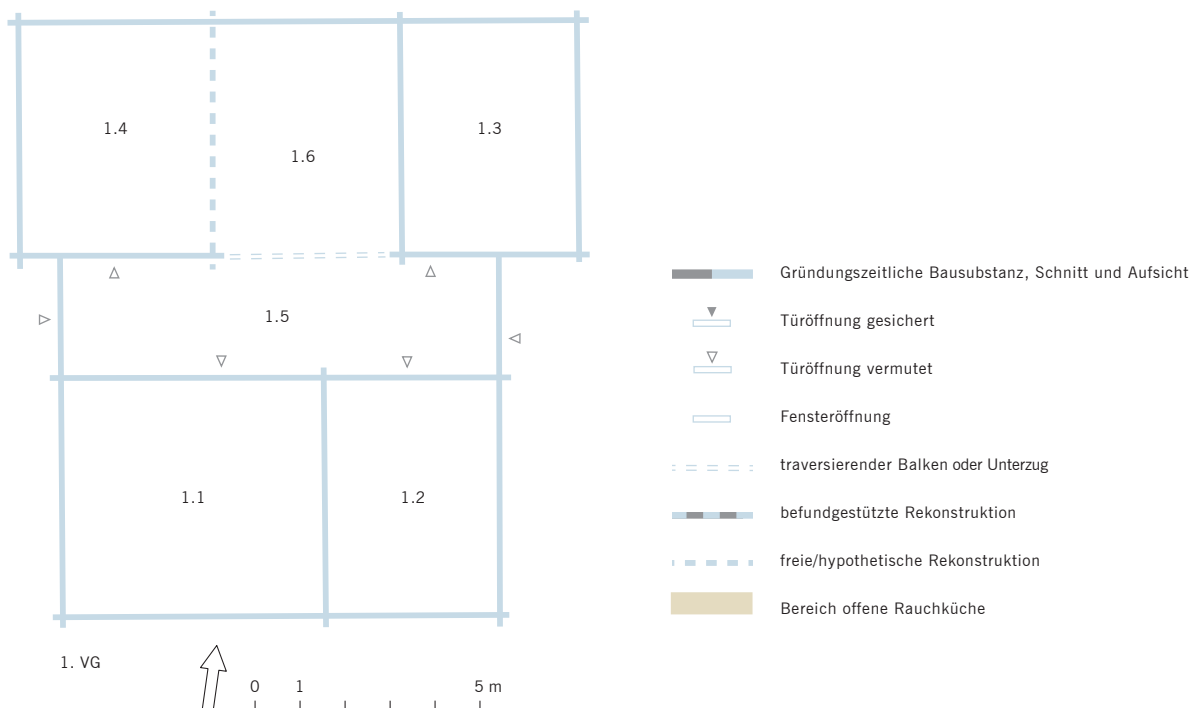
Haus Berchtwil 2 in Risch, rekonstruierter Grundriss des ersten Vollgeschosses.
